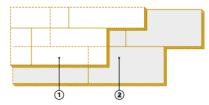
Смещение плит верхнего и нижнего слоев при укладке: 1 — Верхний слой утеплителя; 2 – Плиты нижнего слоя утеплителя
